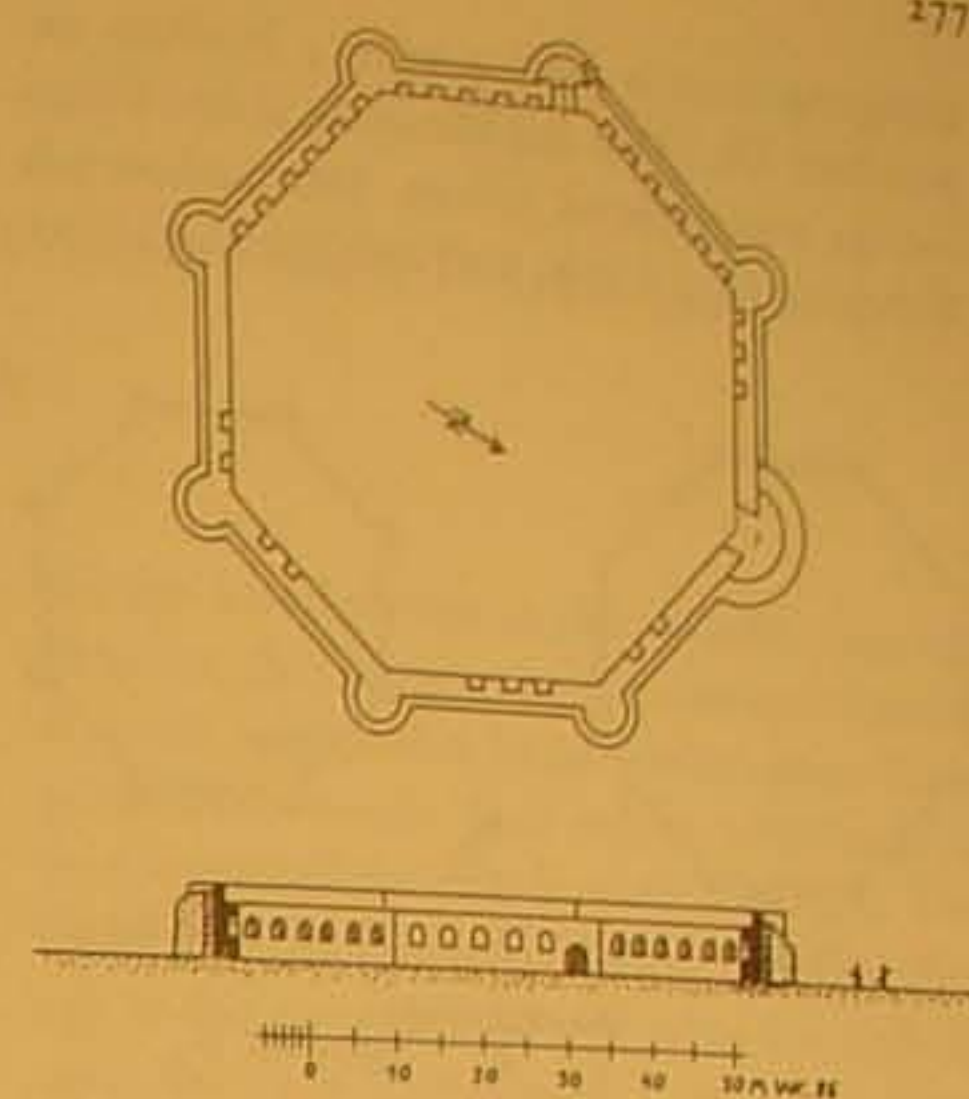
Qal'eh Kharabeh bei Nasrabad, Plan und Schnitt
